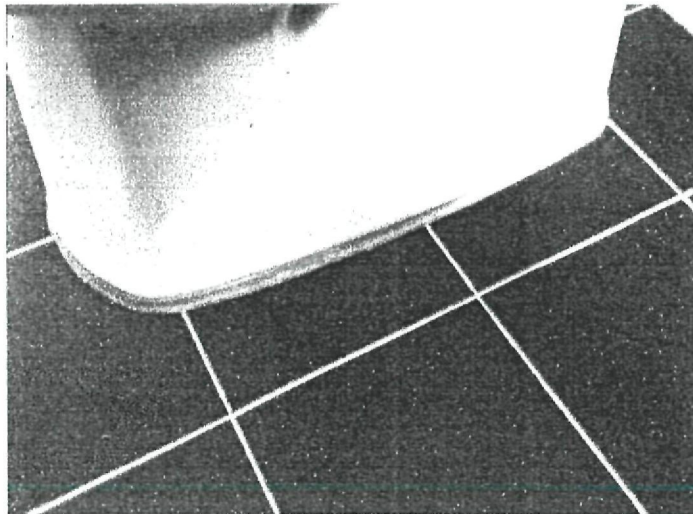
Penyambungan dari "W.C" ke lantai
